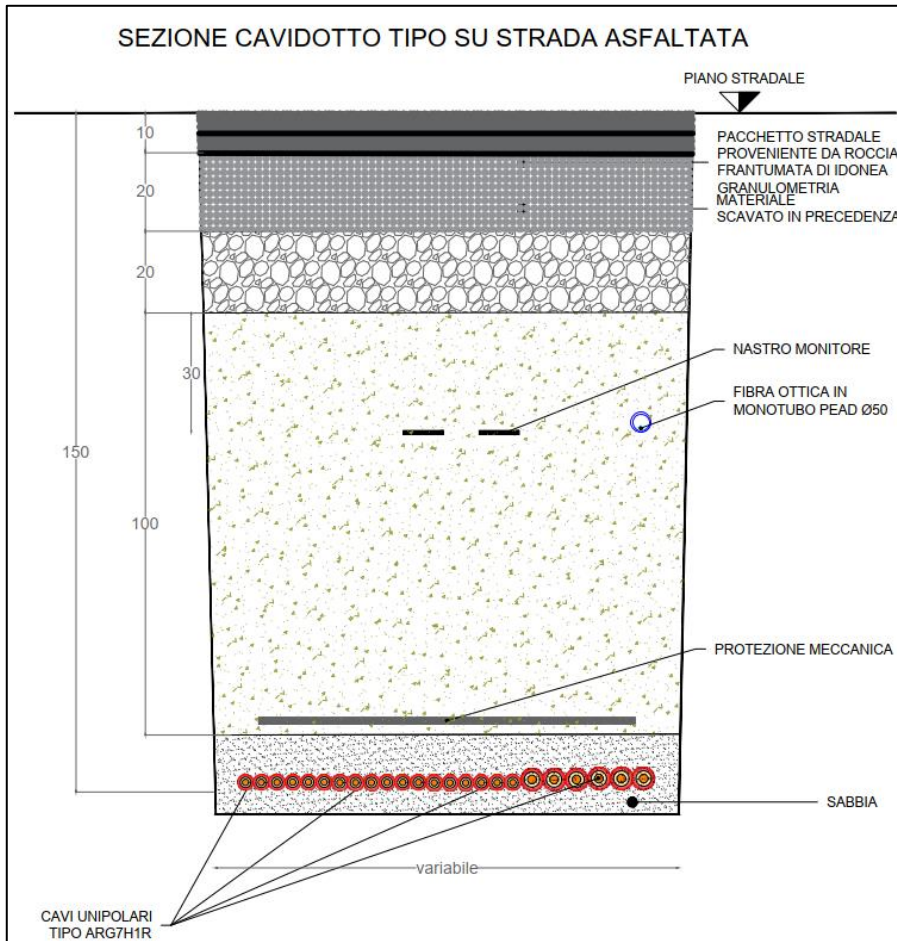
Sezione di posa cavidotto MT a 30 kV – su strada asfaltata
